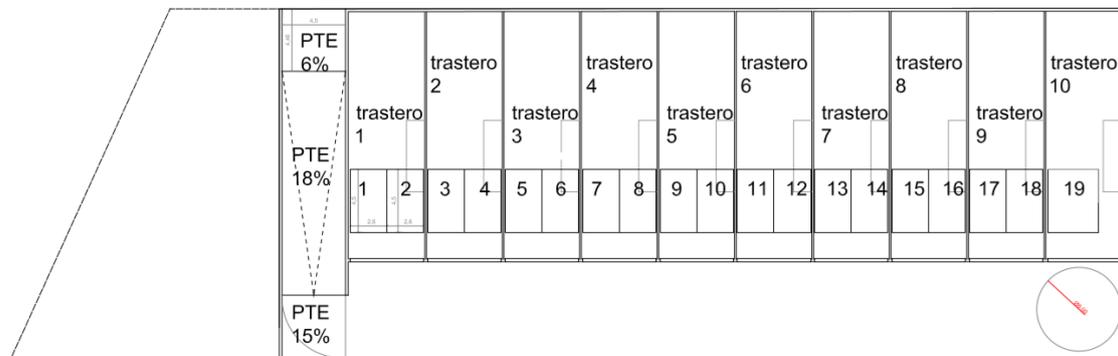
Plano de distribución sótano. Fuente: elaboración propia
